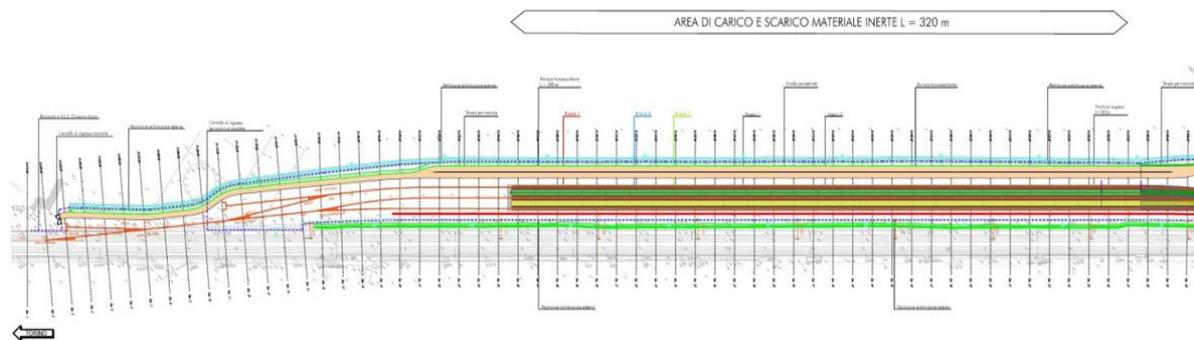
stralcio planimetrico zona raccordo ferroviario torrazza
